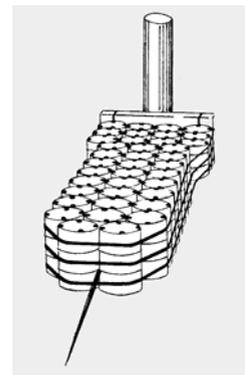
Instalación de barreras en terraplenes (OCDE, 1.975)
